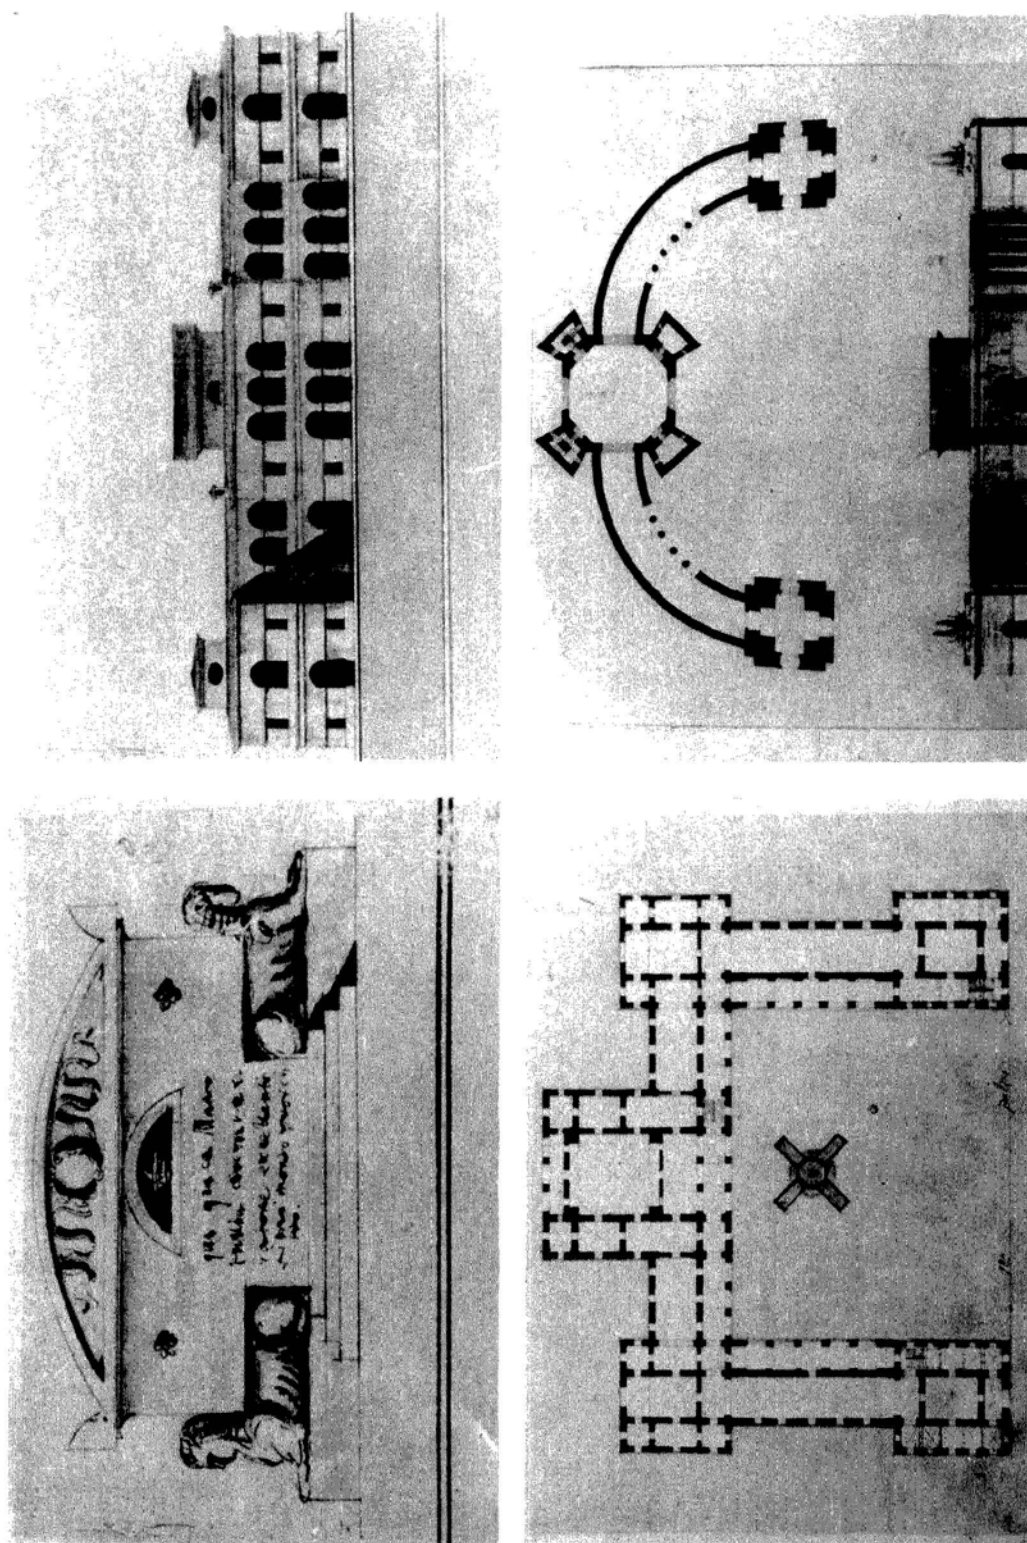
y 6. Biblioteca pública. Planta y sección. Academia de San Fernando. Madrid.
